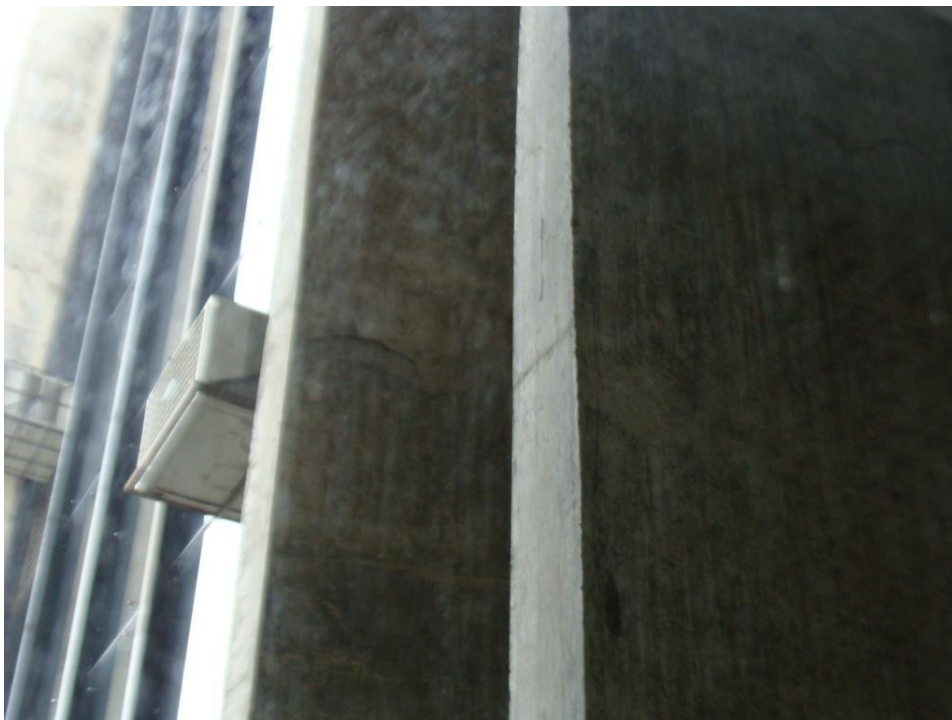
Umidade Pilar P9 (6º andar) (02/03/2021)
